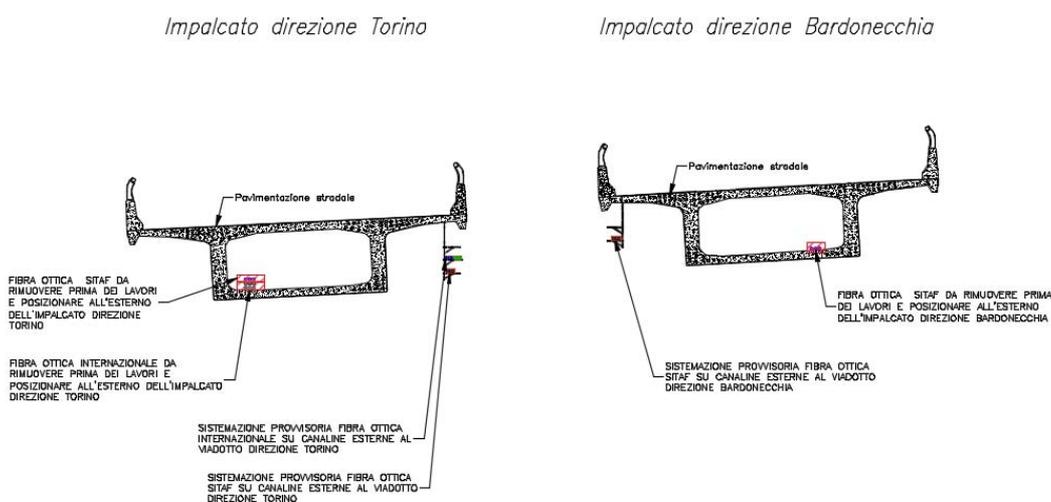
Viadotto Clarea – Posizione fibre ottiche SITAF FASE 1
